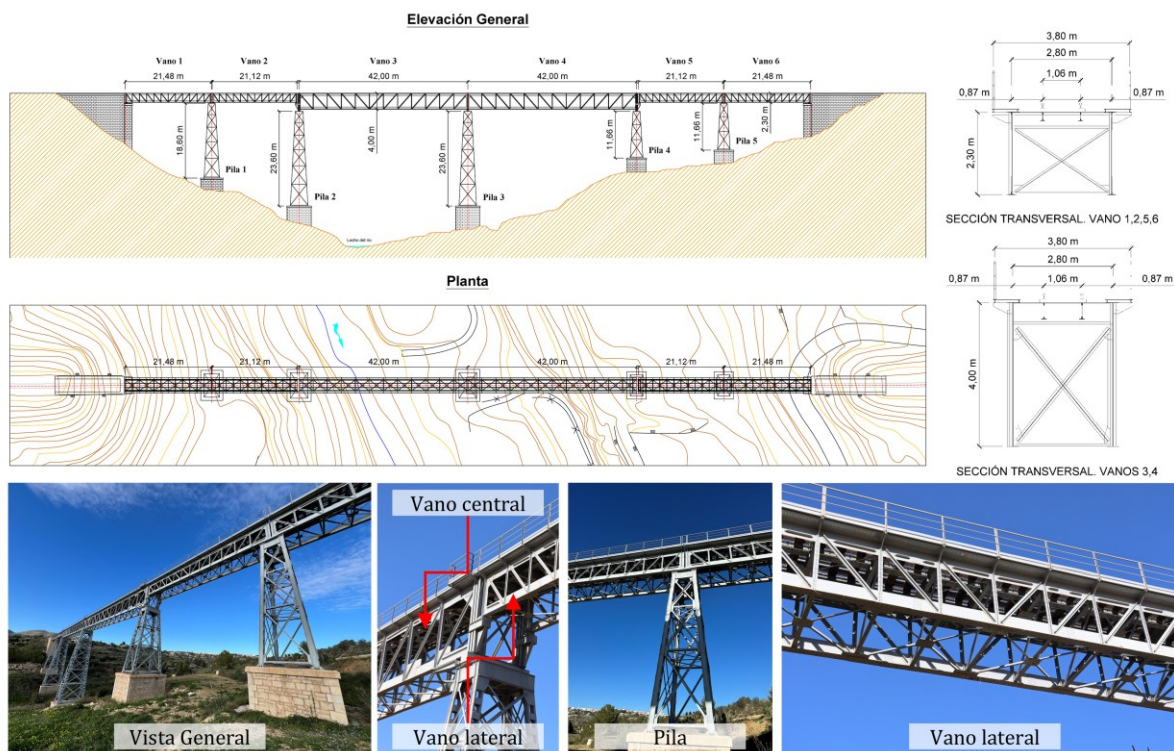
Puente del Quisi: Elevación general, Vista en planta y fotografías generales
